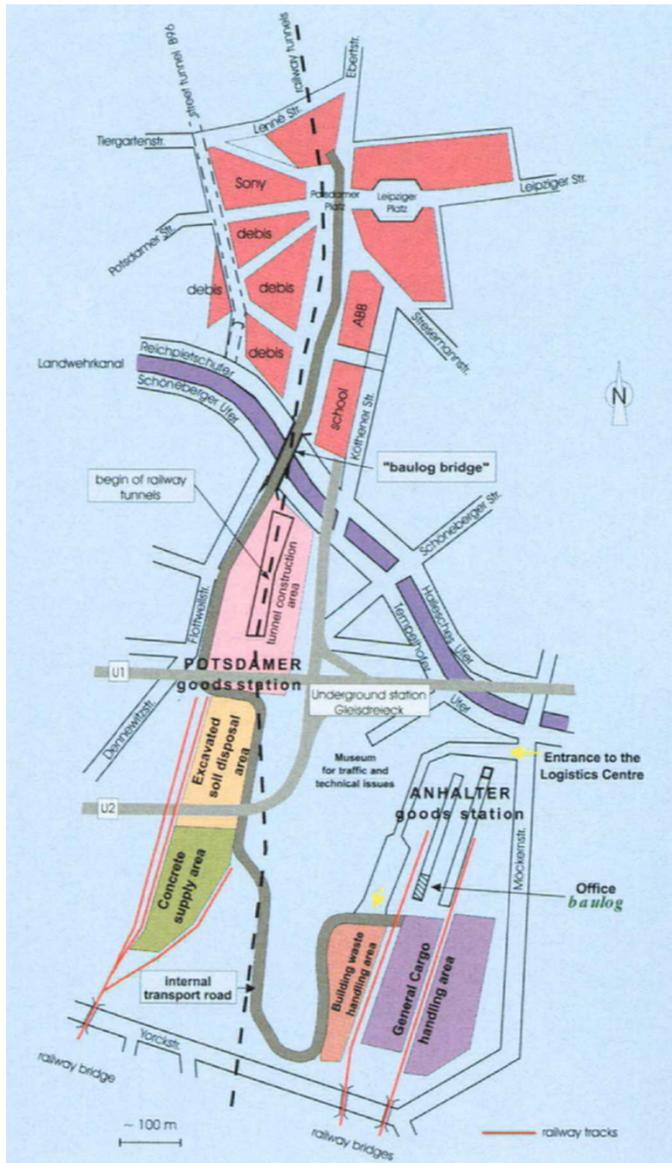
distribuição do canteiro de obras da Potsdamer Platz com estrada interna e centro de logística.
